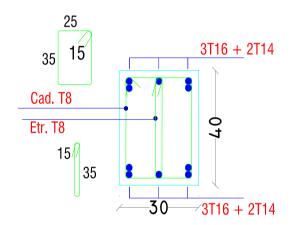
Ferraillage des poutres principales pour Etage 7.
